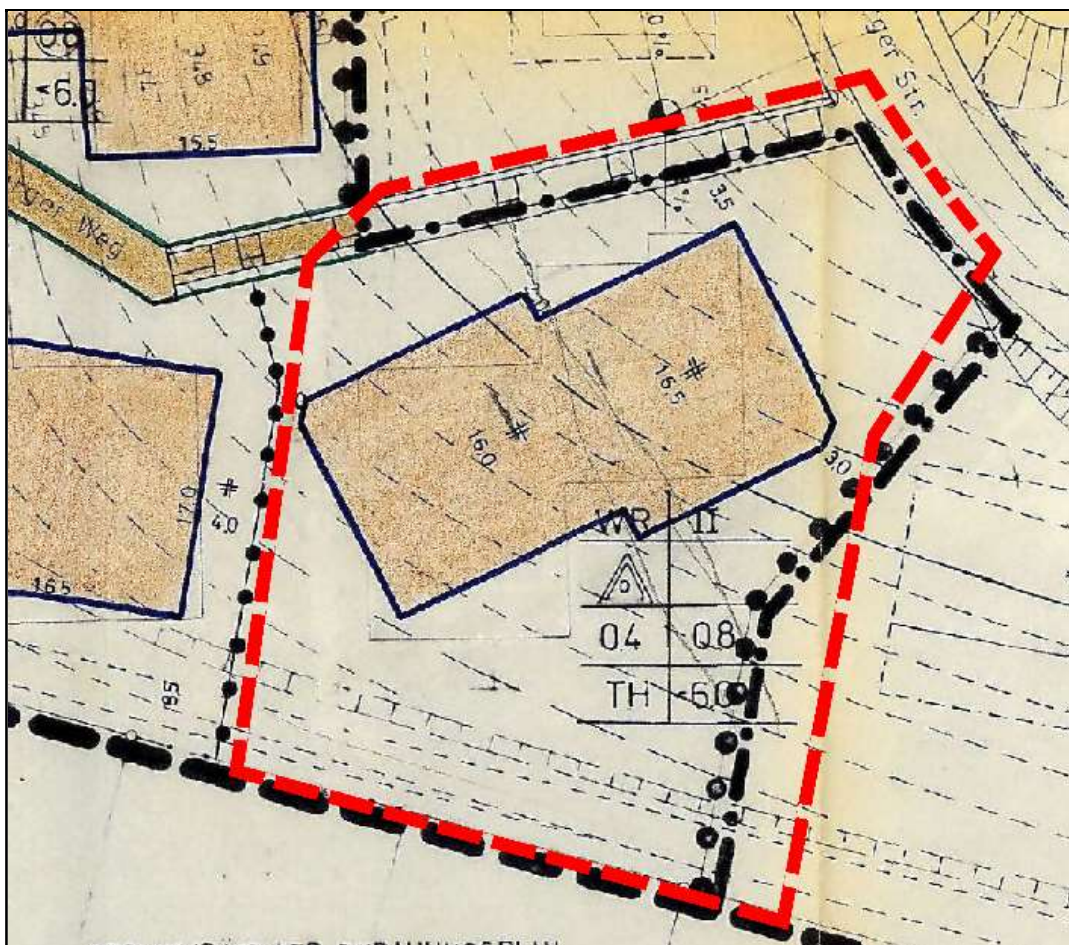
Bebauungsplan Nr. 6, 4. Änderung, Bestand, ohne Maßstab, (Quelle: © Stadt Netphen)
